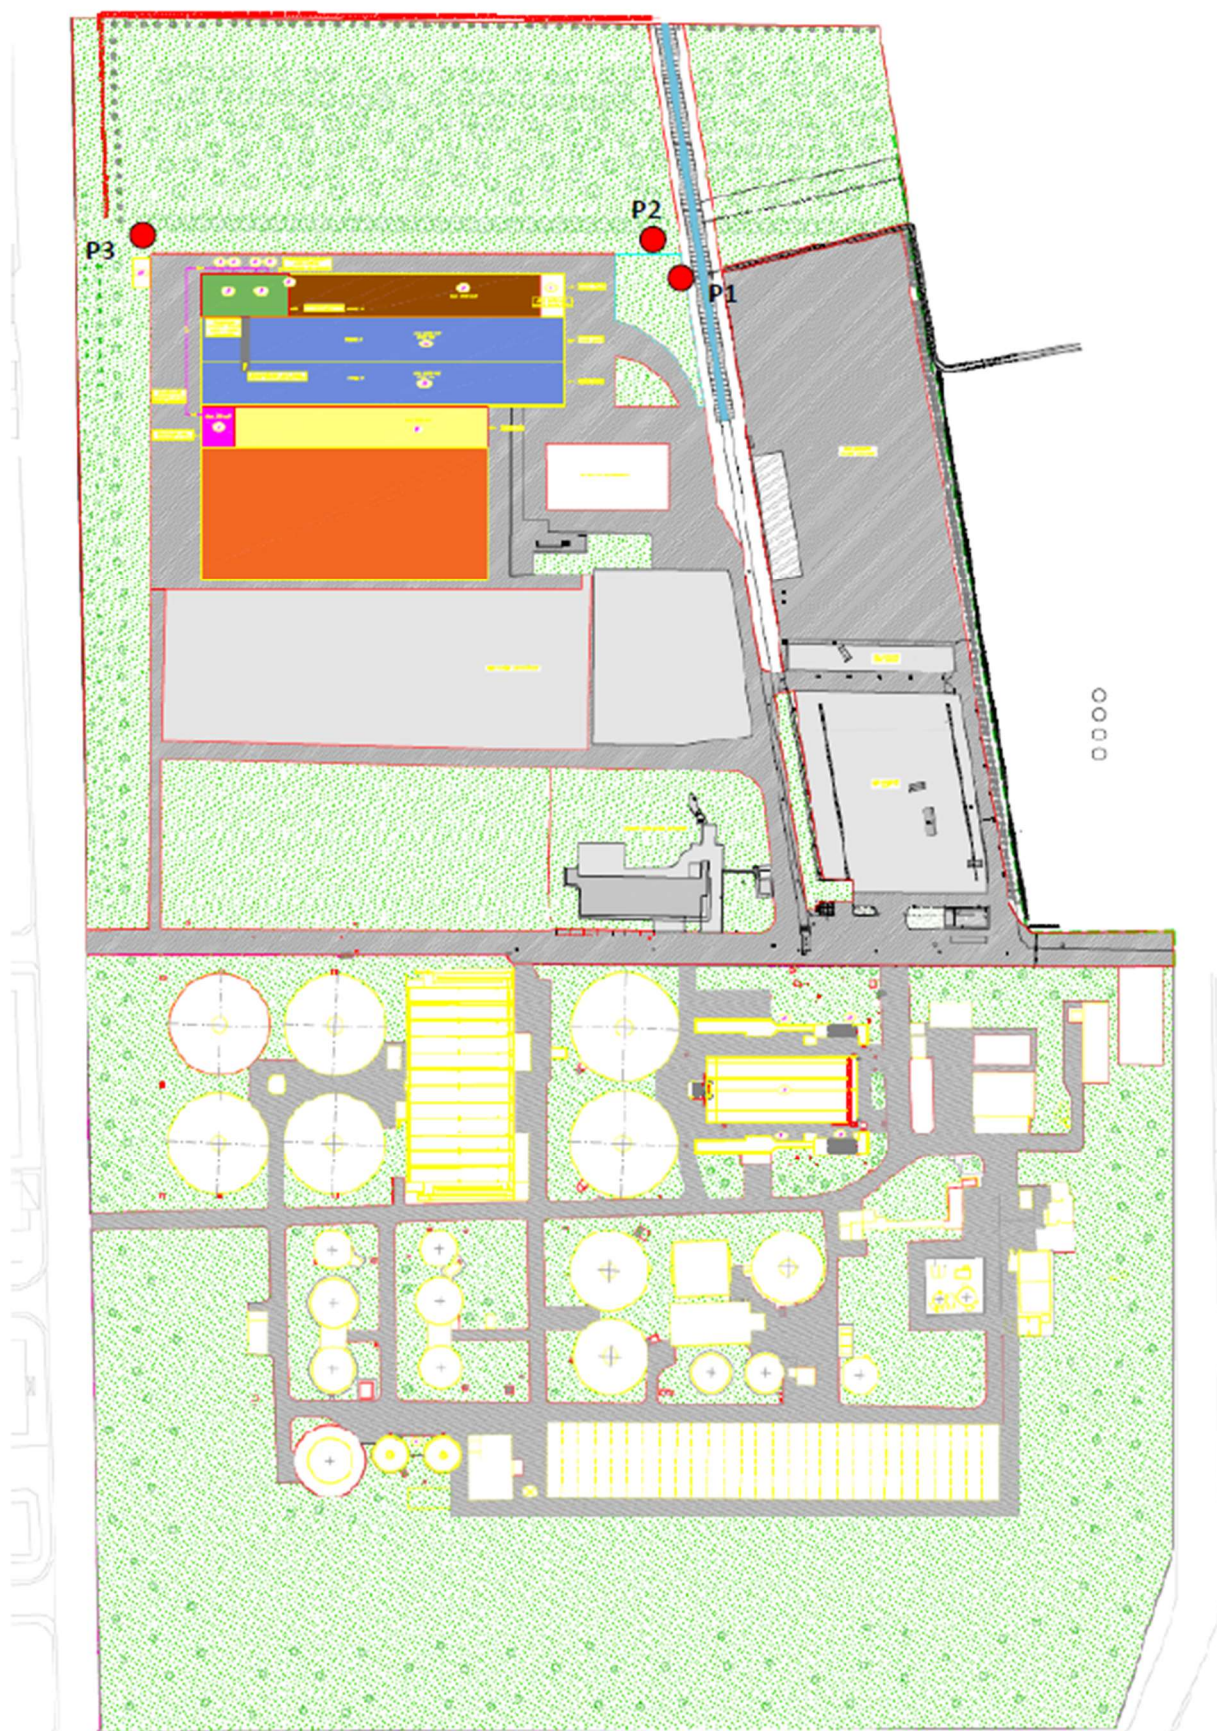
Ubicazione dei punti di campionamento sulla planimetria di progetto dell'opera
